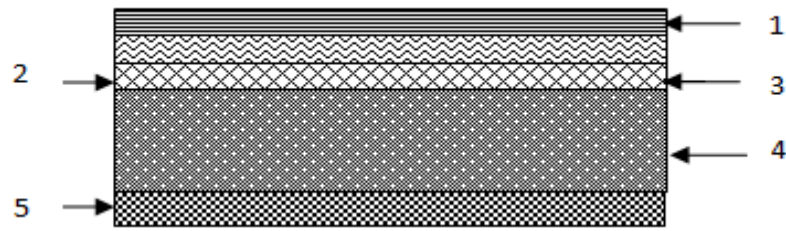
Coupe transversale dans le plancher à dalle pleine.
